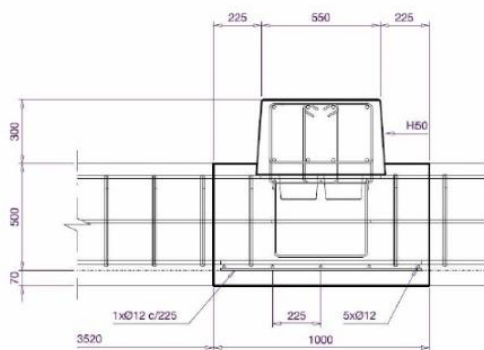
Detalle de la conexión de la viga de cimentación en cimentación *in situ
